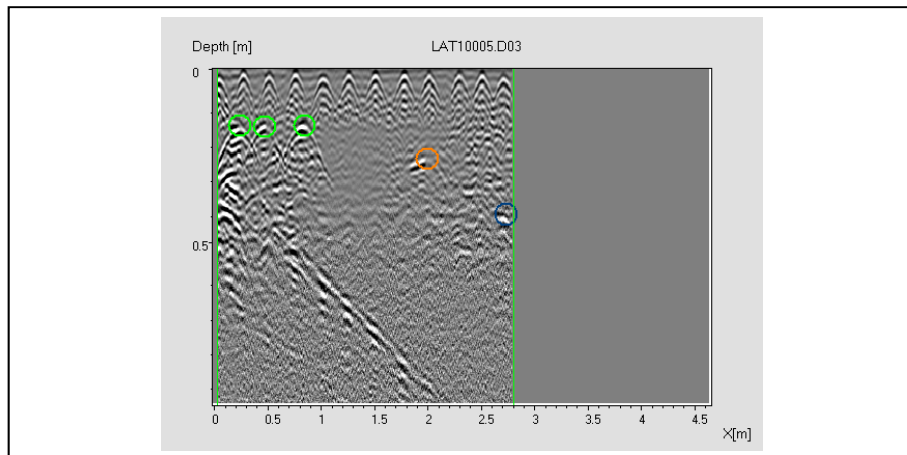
SEZIONE LONGITUDINALE PORZIONE A (ORIZZONTALE) LAT10005
